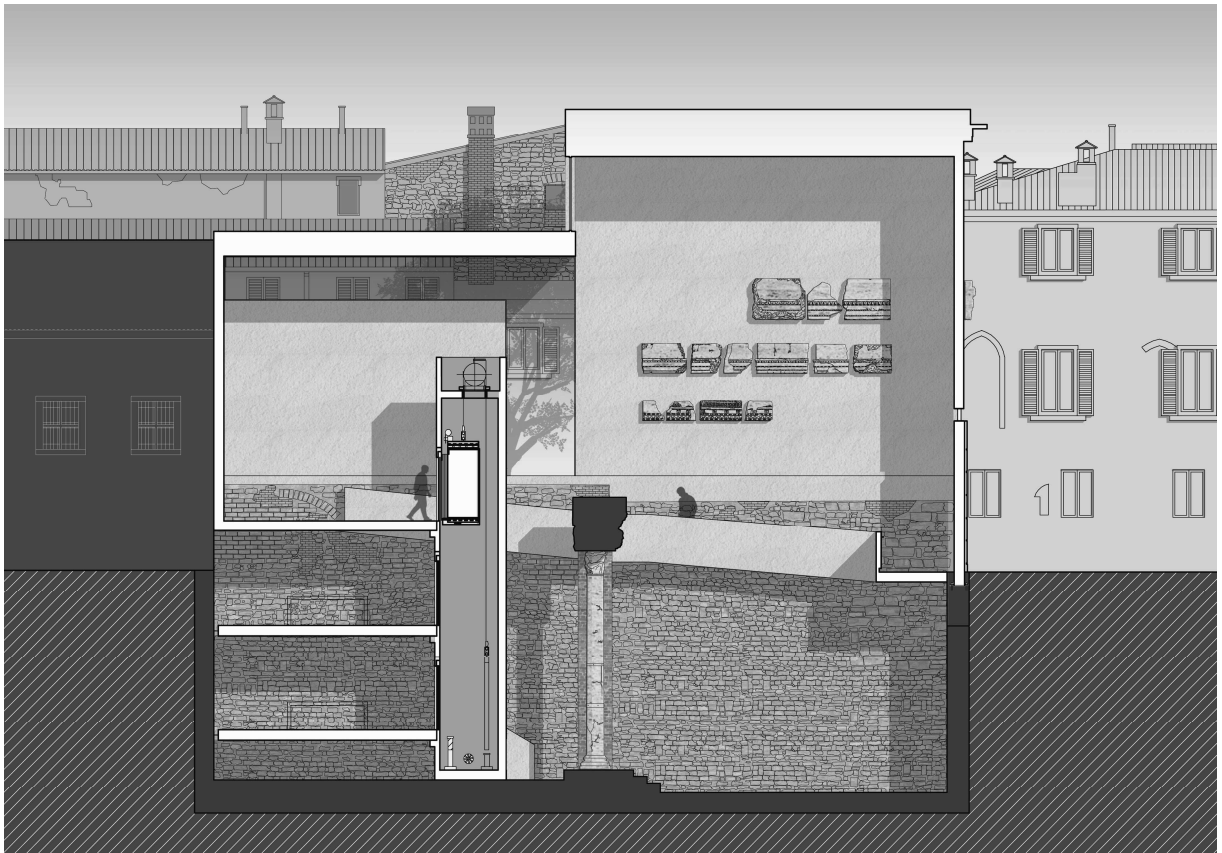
Sezione longitudinale dell'edificio di Progetto in Piazza Foro
